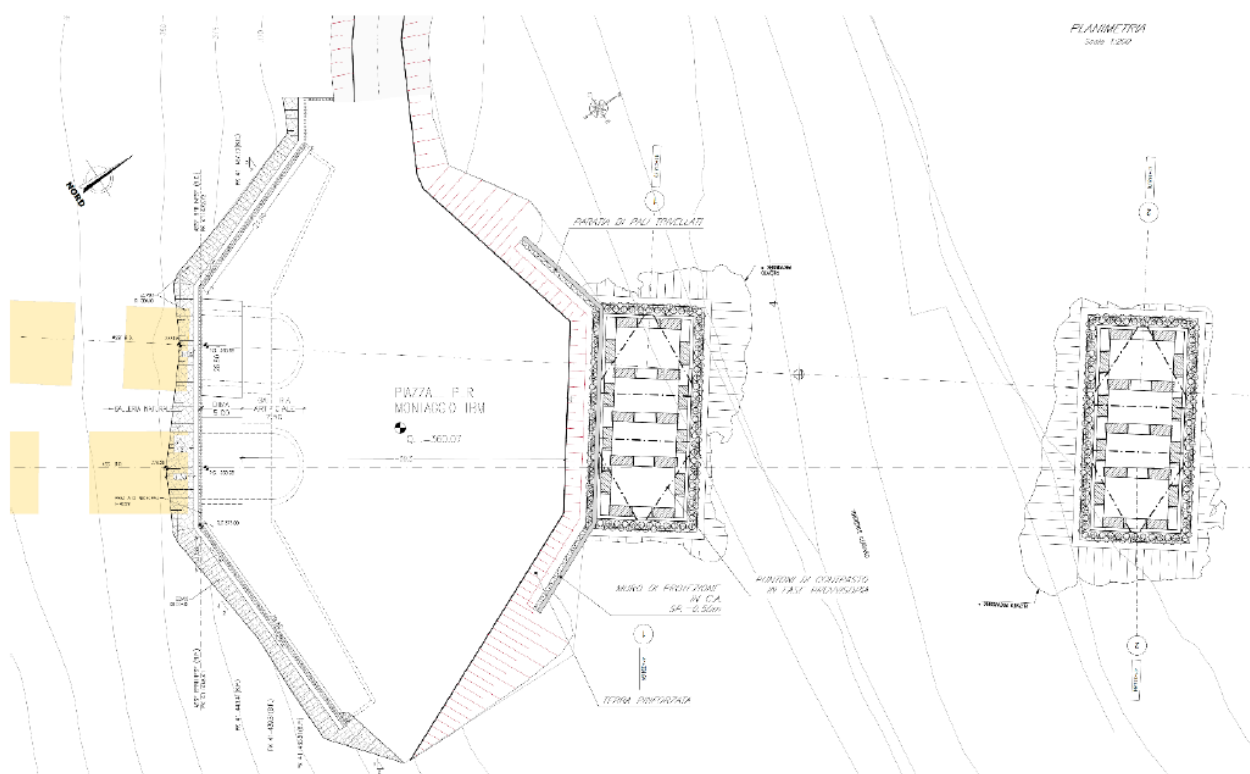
Imbocco lato Bari GN01 –allargamento piazzale di lavoro antistante la galleria - Pianta
